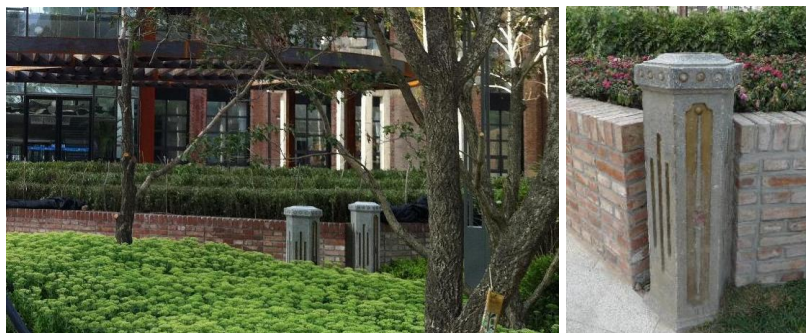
Бетонные столбы главной внутренней лестницы офисного здания, использованные в качестве торцевых элементов ограждения садовой дорожки
